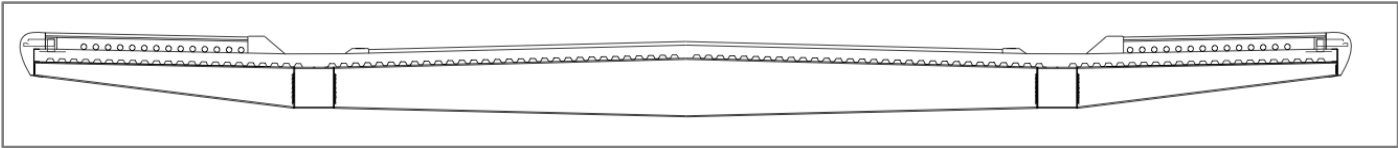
Sección tipo planteada Alternativa nº 1. Tablero.
